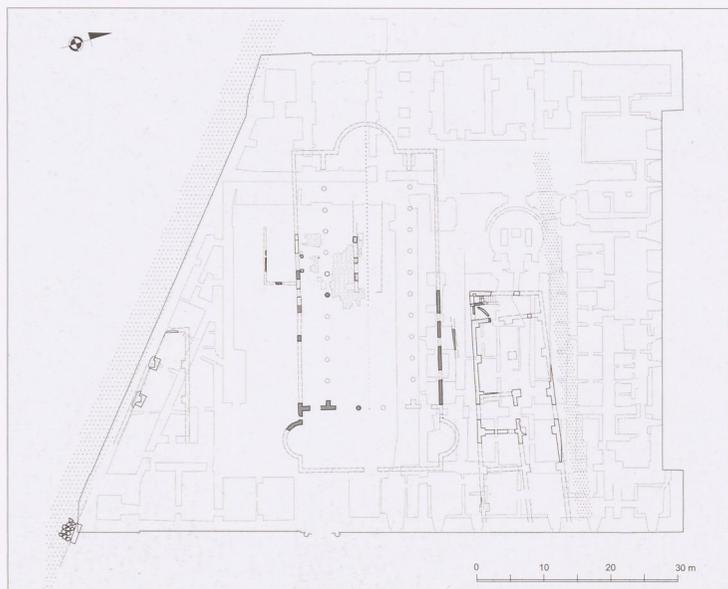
Basilica di San Lorenzo: ricostruzione della planimetria originaria secondo R. Krautheimer (dis. G. Schingo).
